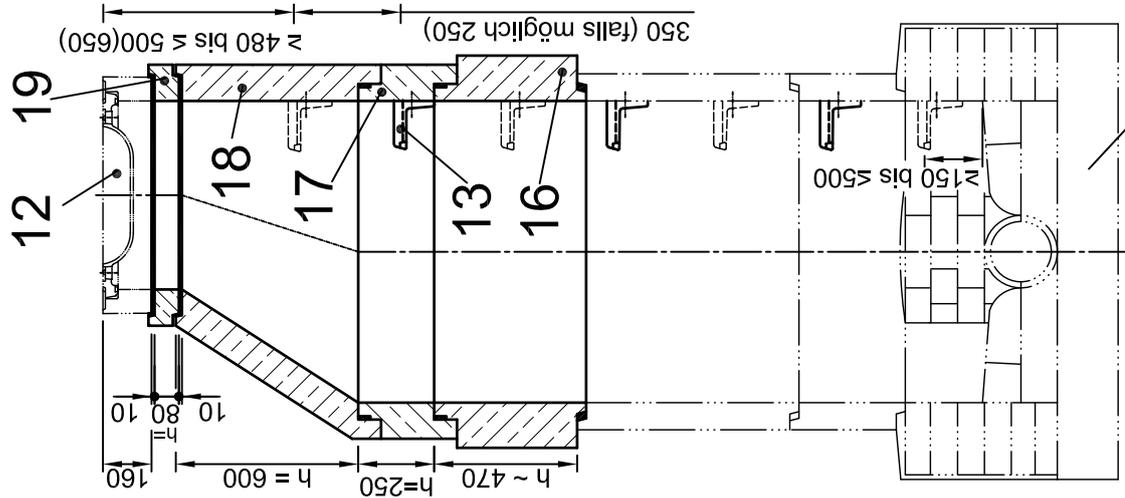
Vorhandener Einsteigschacht DN 1000
